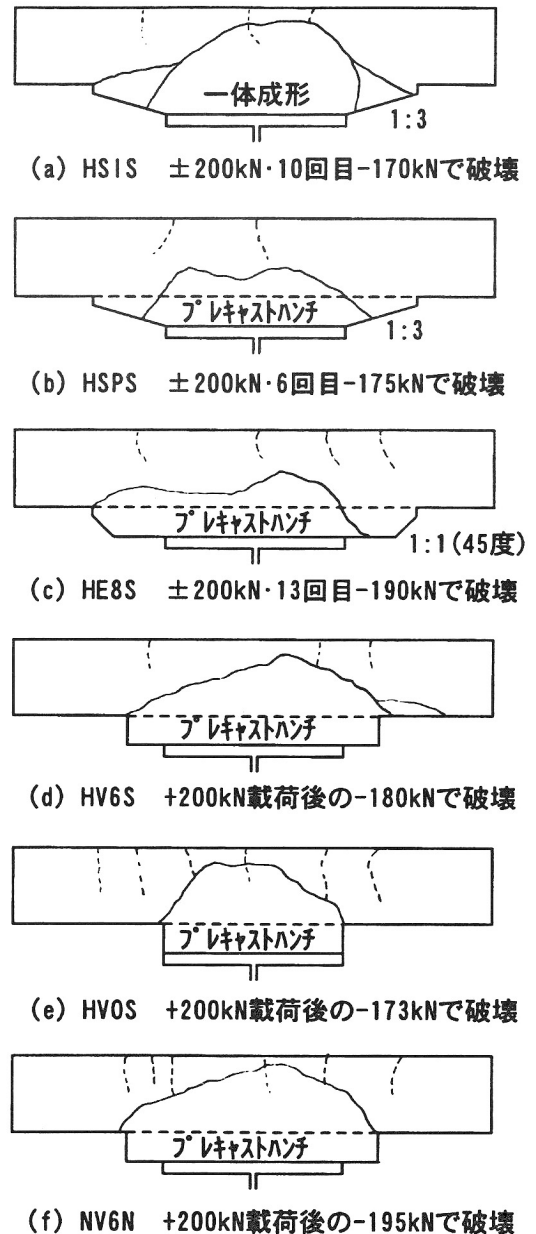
破壊荷重とコンクリートのひび割れ性状
